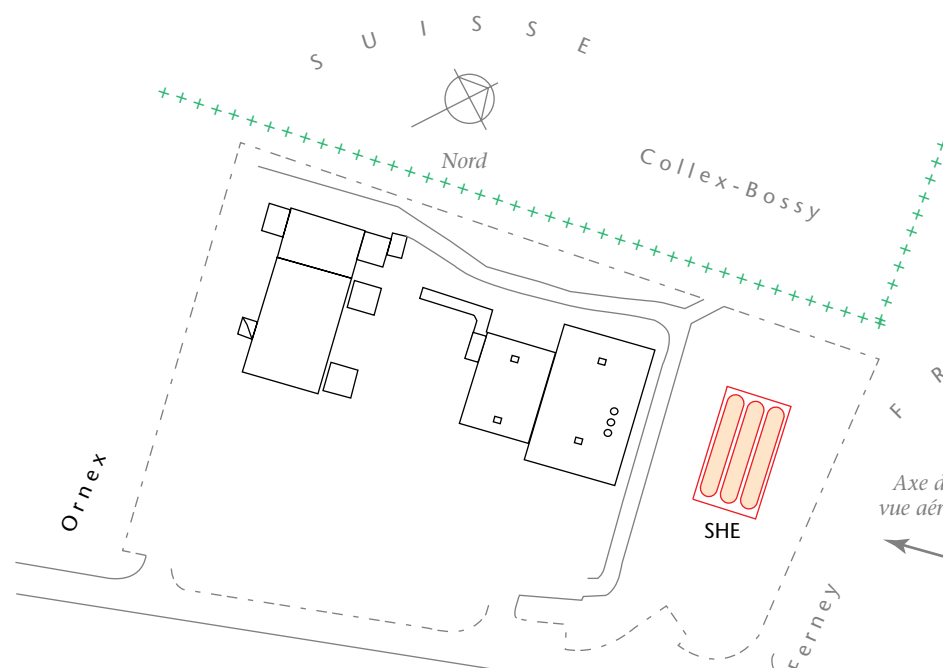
Plan de masse des ouvrages de surface au Point 7.1
